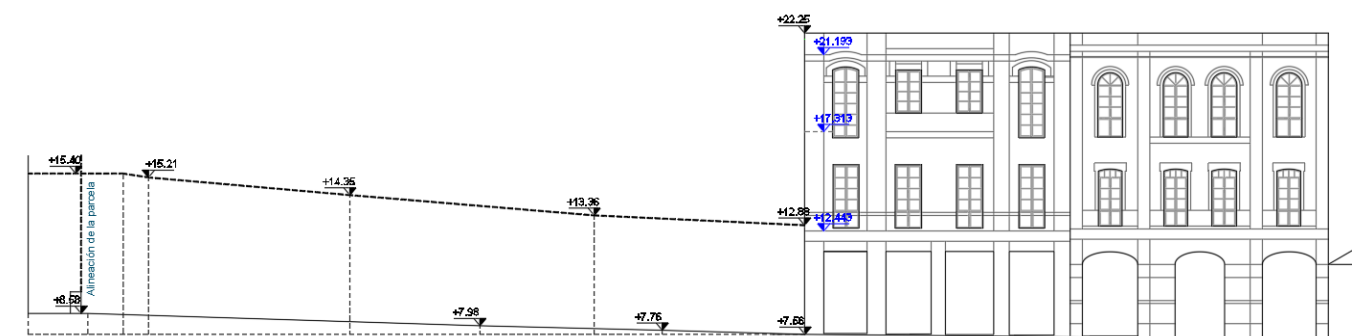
Alzado de la edificación catalogada en la C/Antonio Domínguez Alfonso
